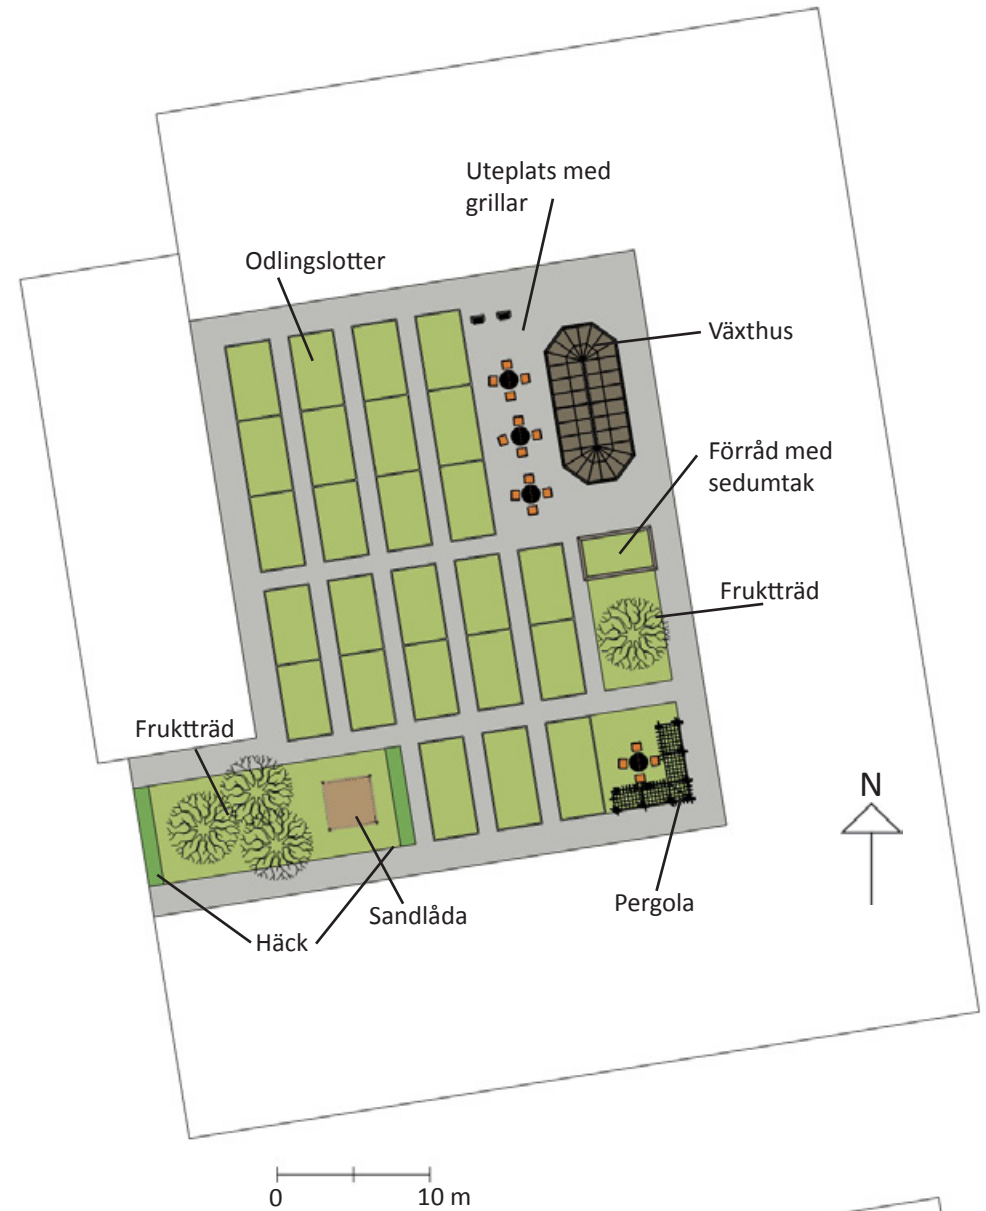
Plan över innergården. Illustration: Fanny Jacobsson
